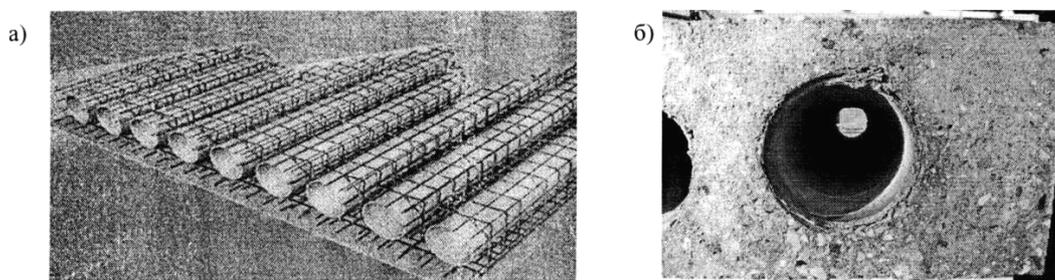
Монолитная железобетонная плита с пустотообразователями в виде труб:
